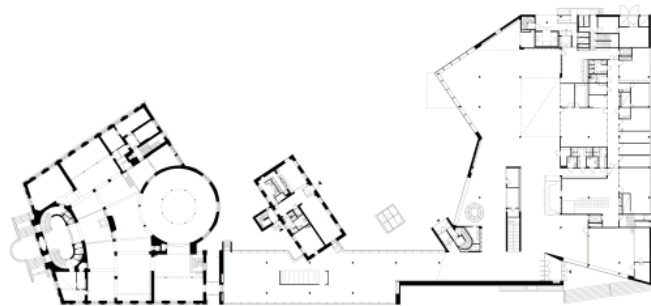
Grundriss, Turku Hauptbibliothek
